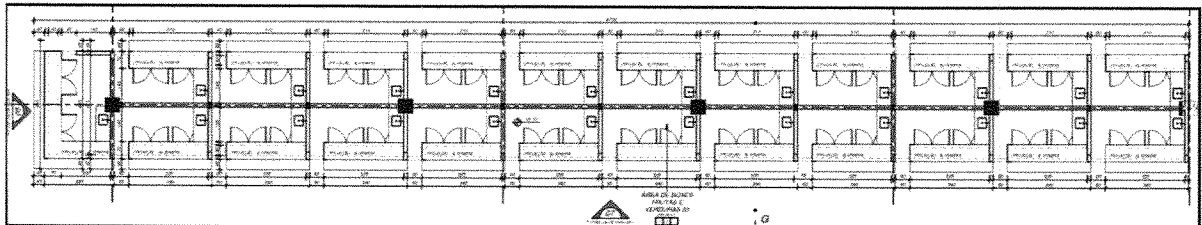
Box de Frutas e Verduras - Planta Baixa
